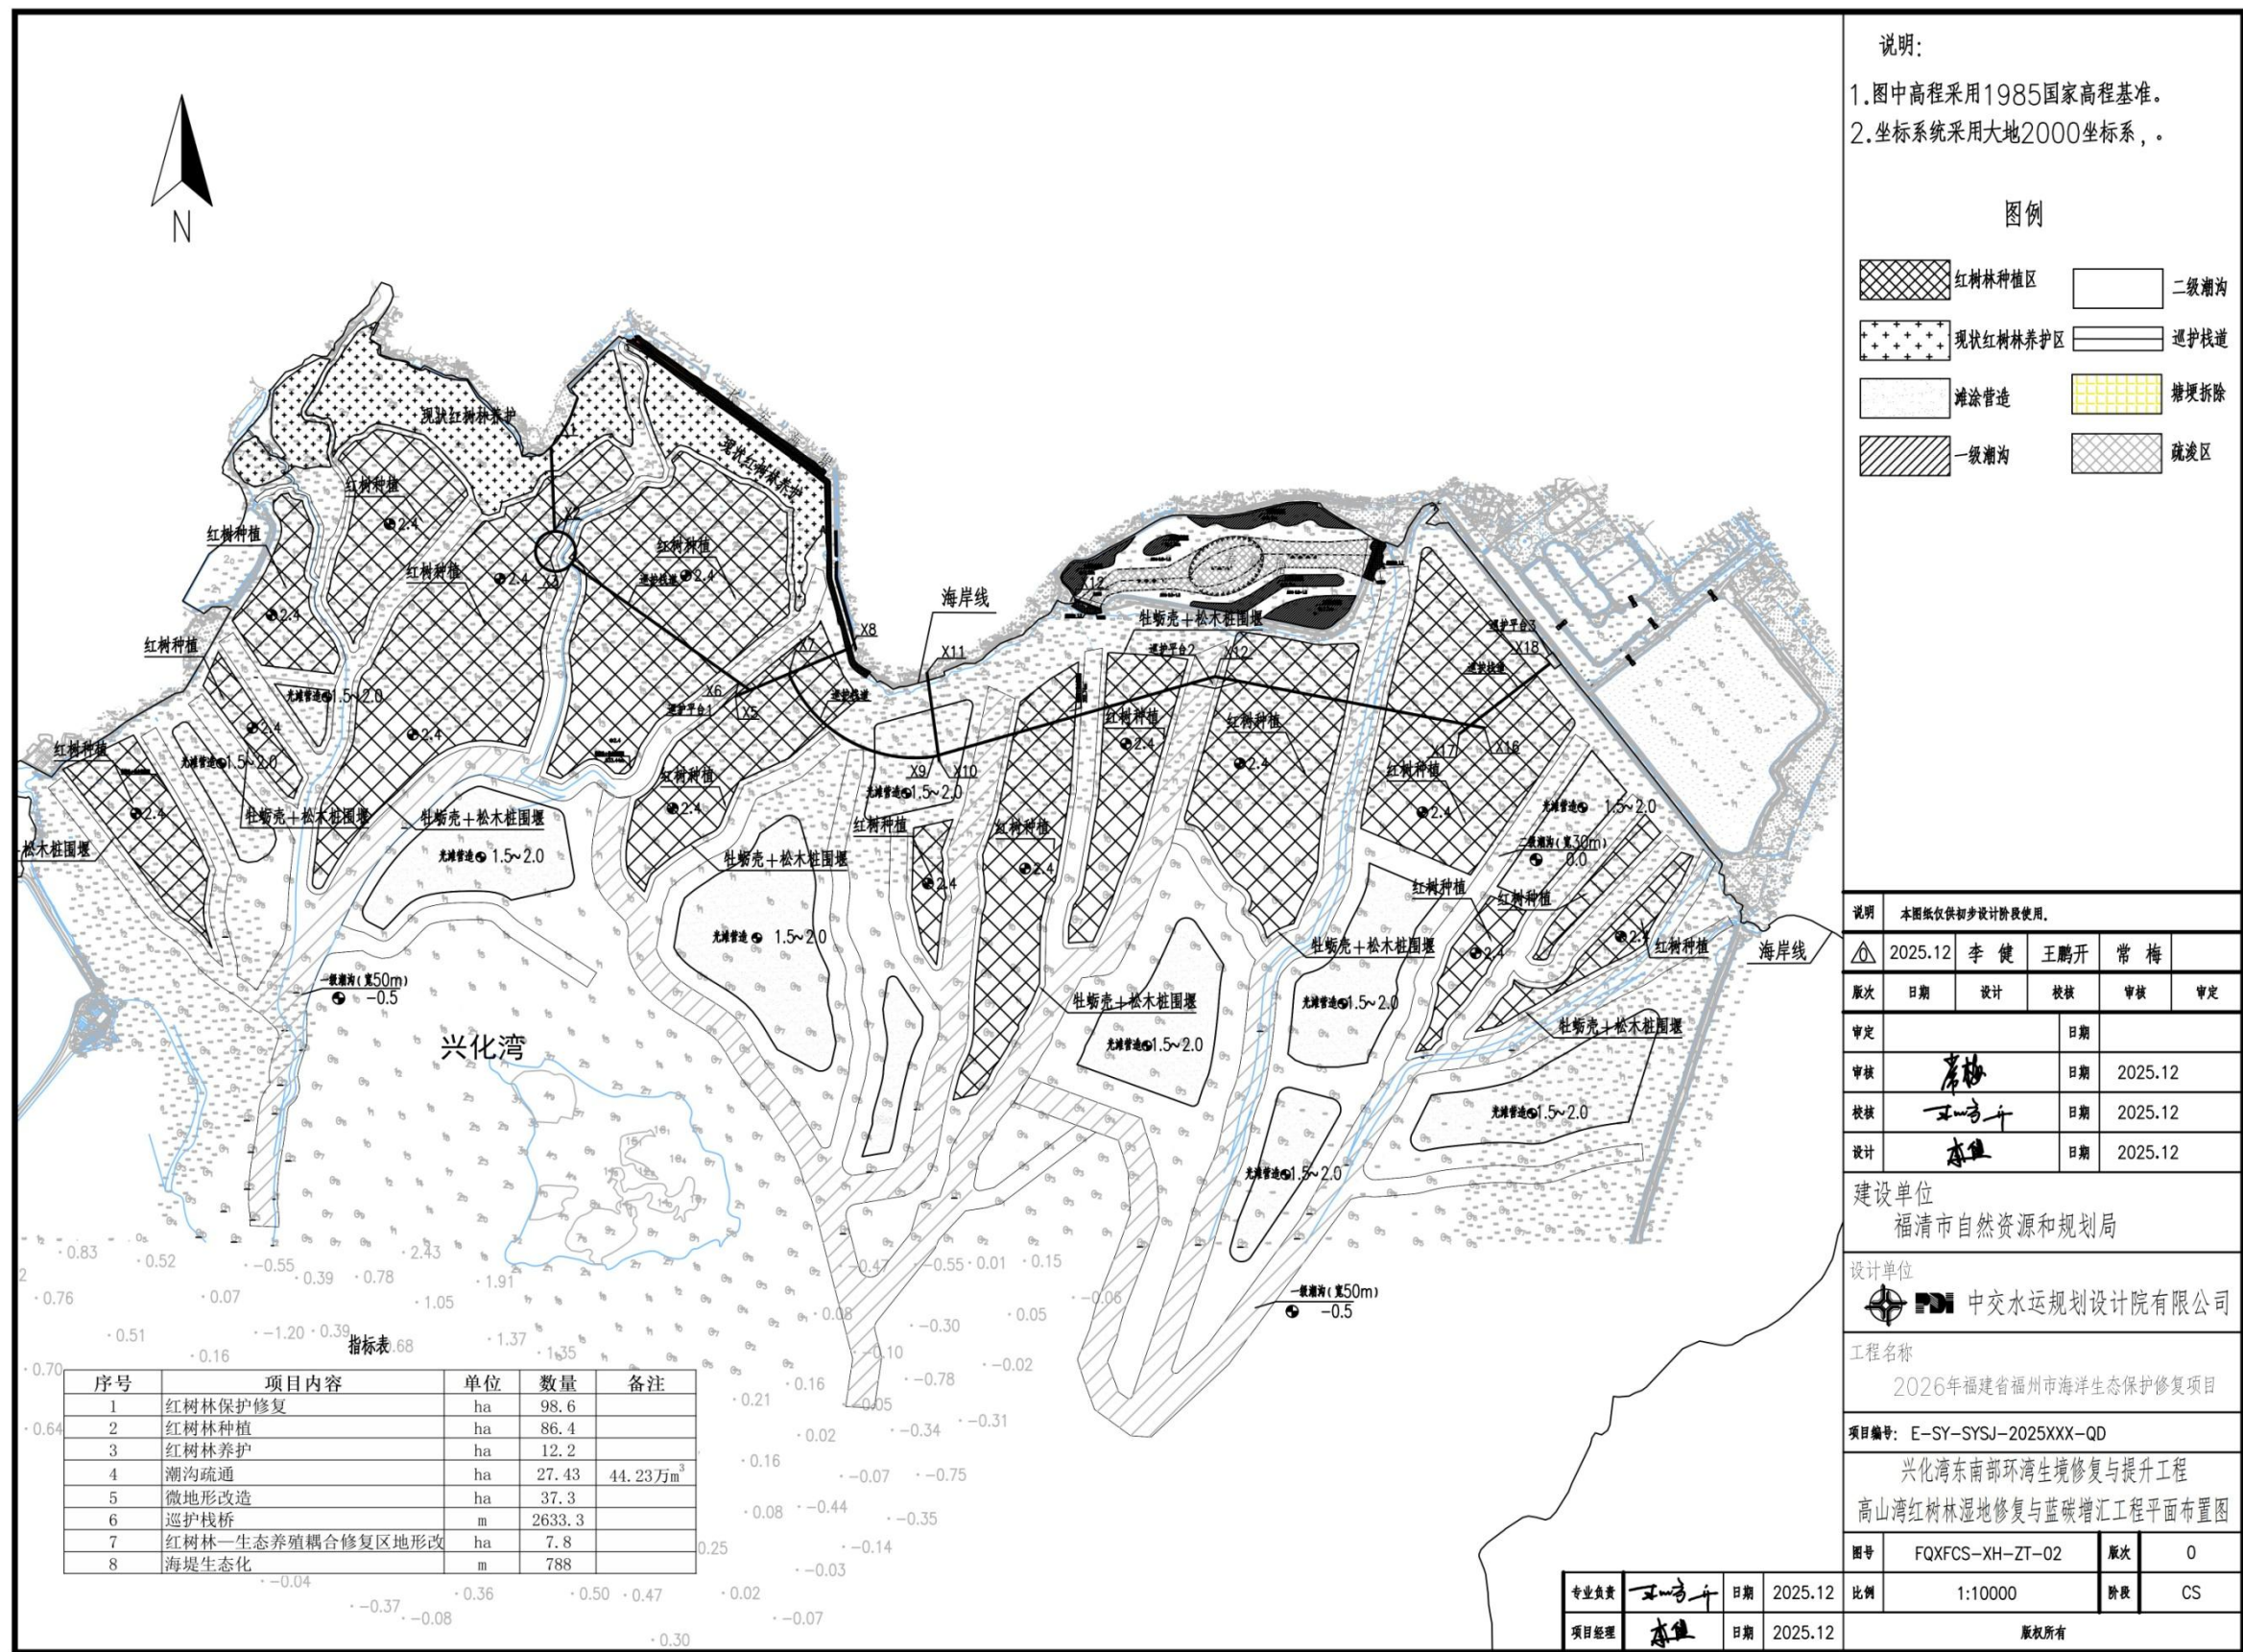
高山湾红树林湿地修复与蓝碳增汇工程平面布置图
